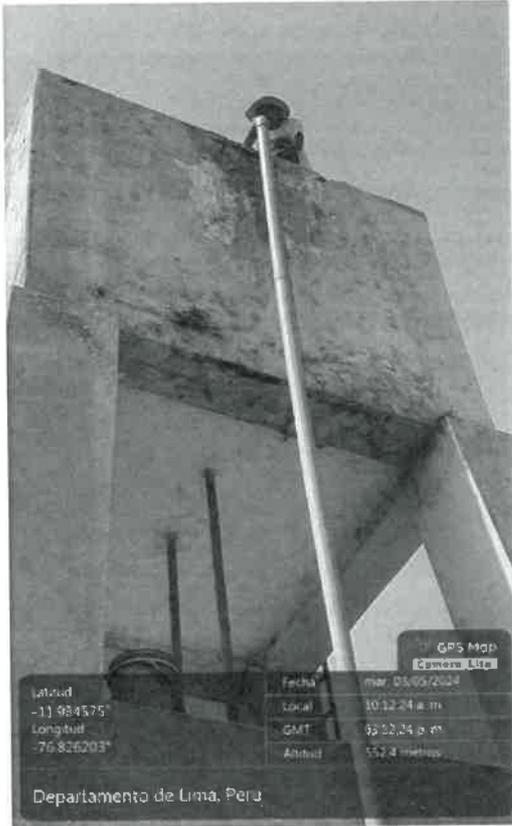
Vista exterior del tanque elevado, se pueden ver fisuras en la estructura
